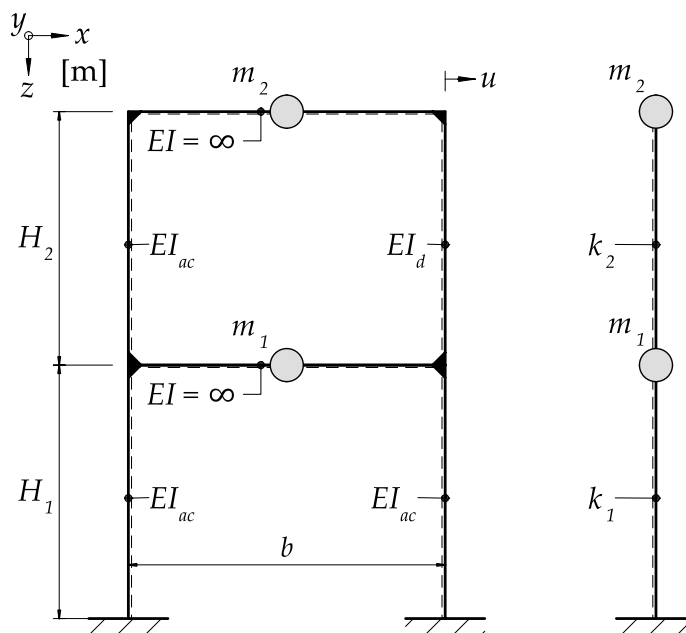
Statisches System des zweistöckigen Gebäudes
